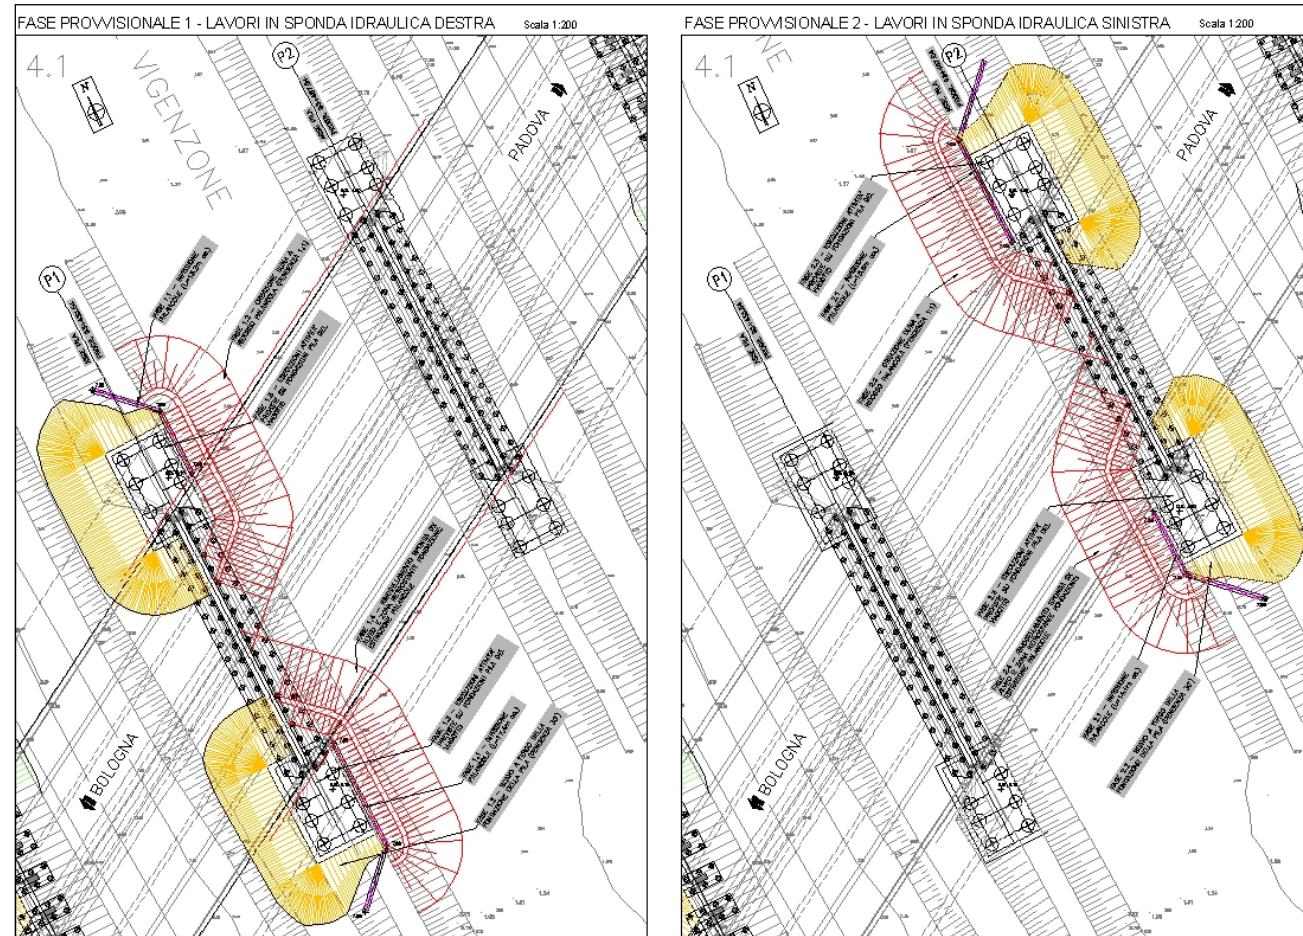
Canale Vigenzona fasi attuative lavori in alveo
